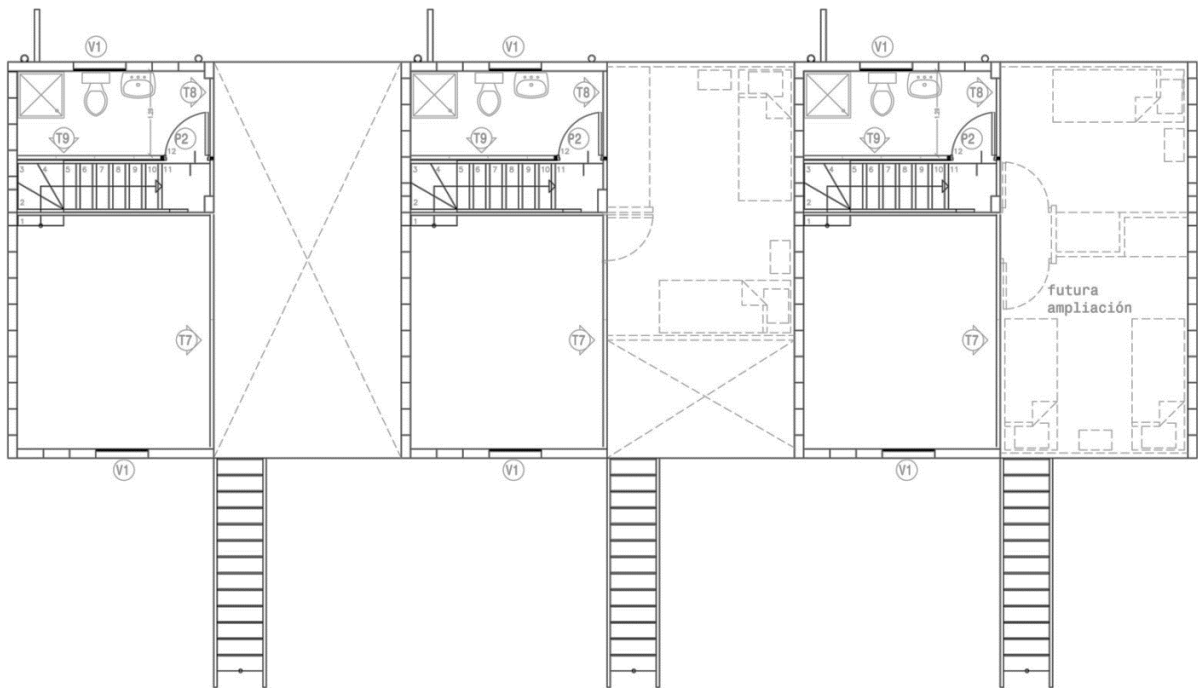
Projeto de arquitetura (planta baixa do 3º pavimento) do Quinta Monroy, Chile
